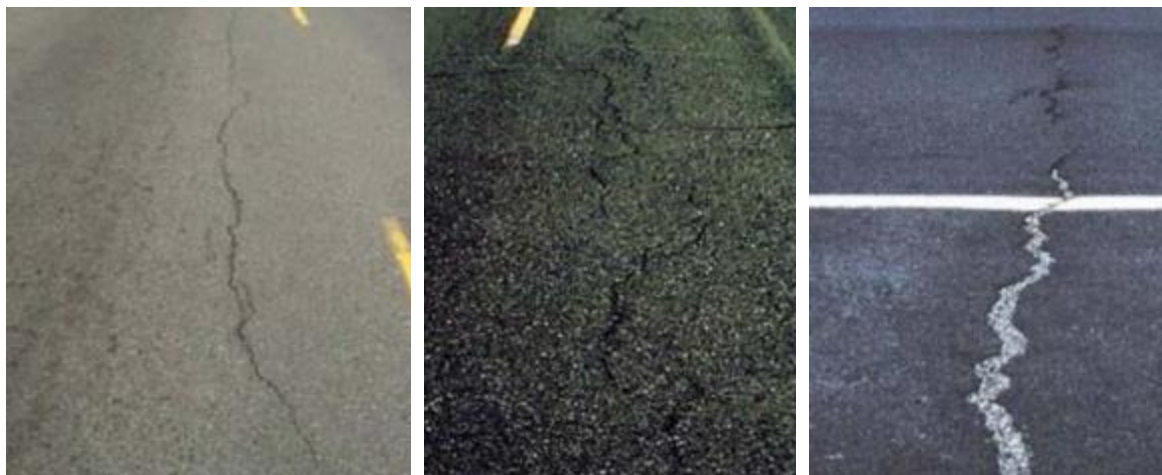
Grietas de tipo transversal y longitudinal de baja, media y alta severidad
